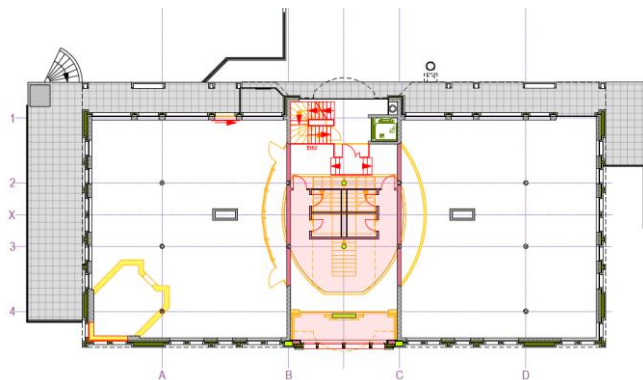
Plan du rez-de-chaussée nord après transformation.
